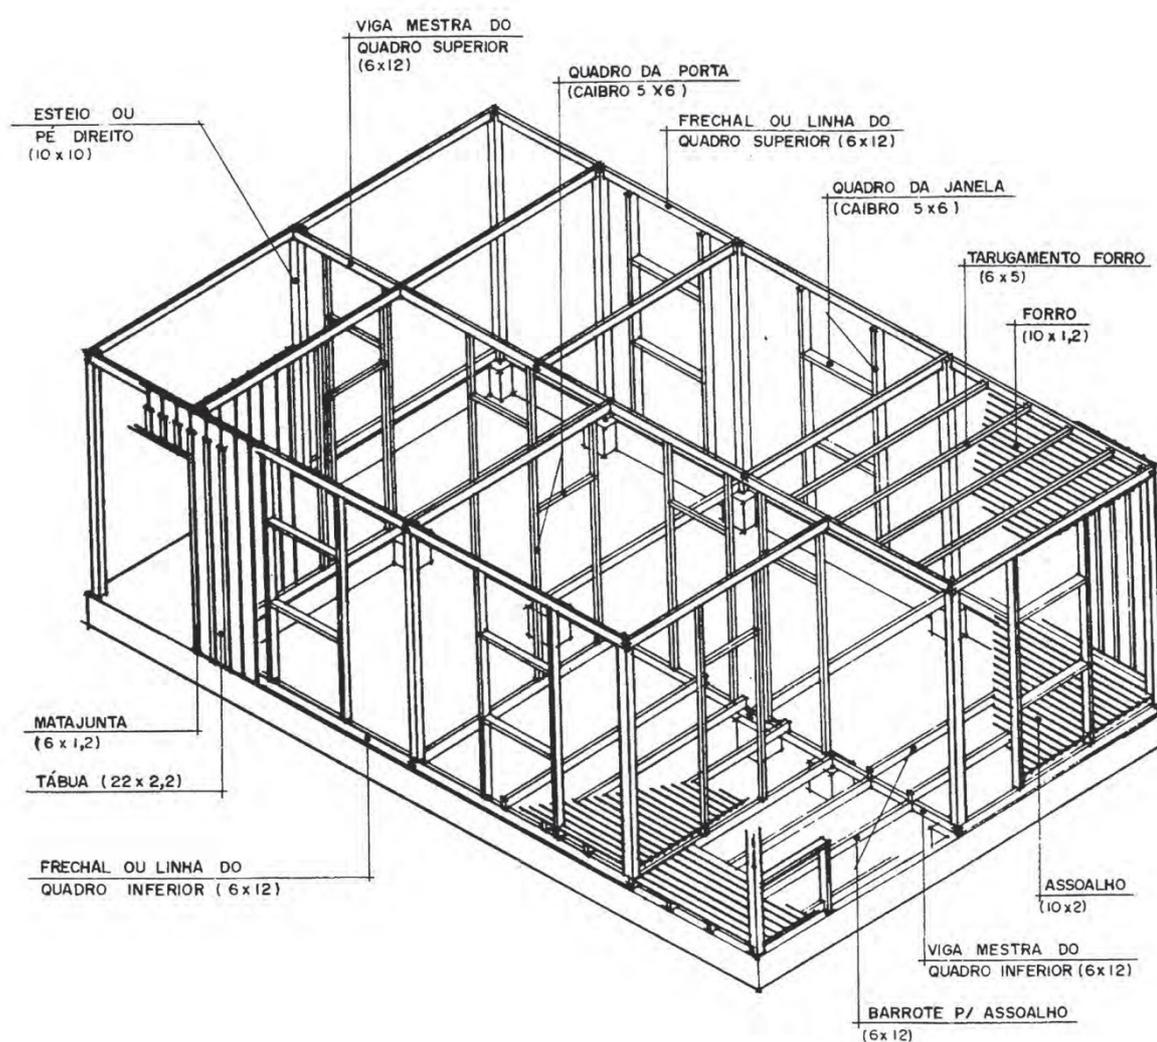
Esquema estrutural de um pavimento de uma casa de Tábua e mata-junta
